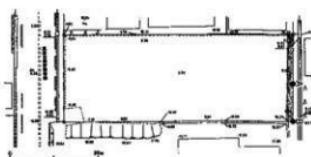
工事立会平面図 (1/1,000)・断面図 (1/100)
